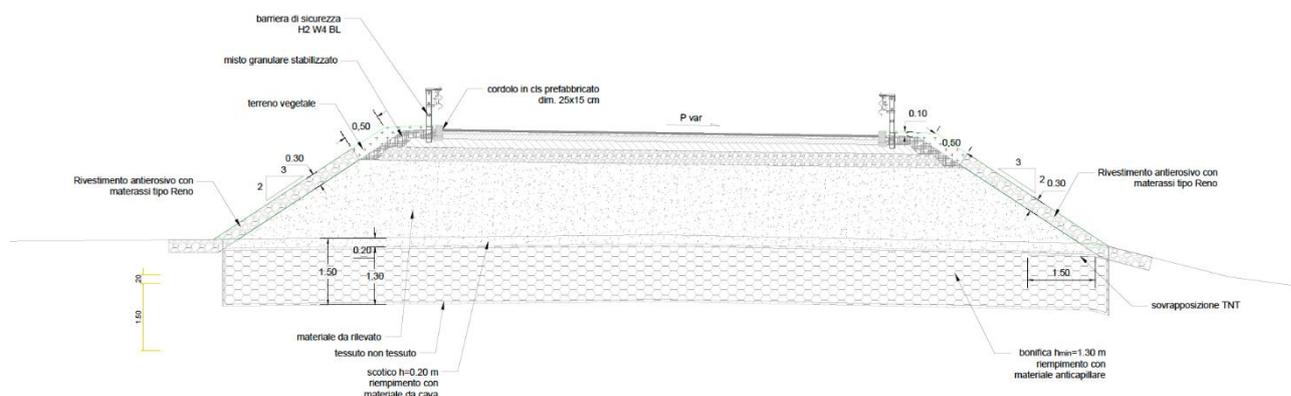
Sezioni tipo rilevato con protezione mediante rivestimento antierosivo
